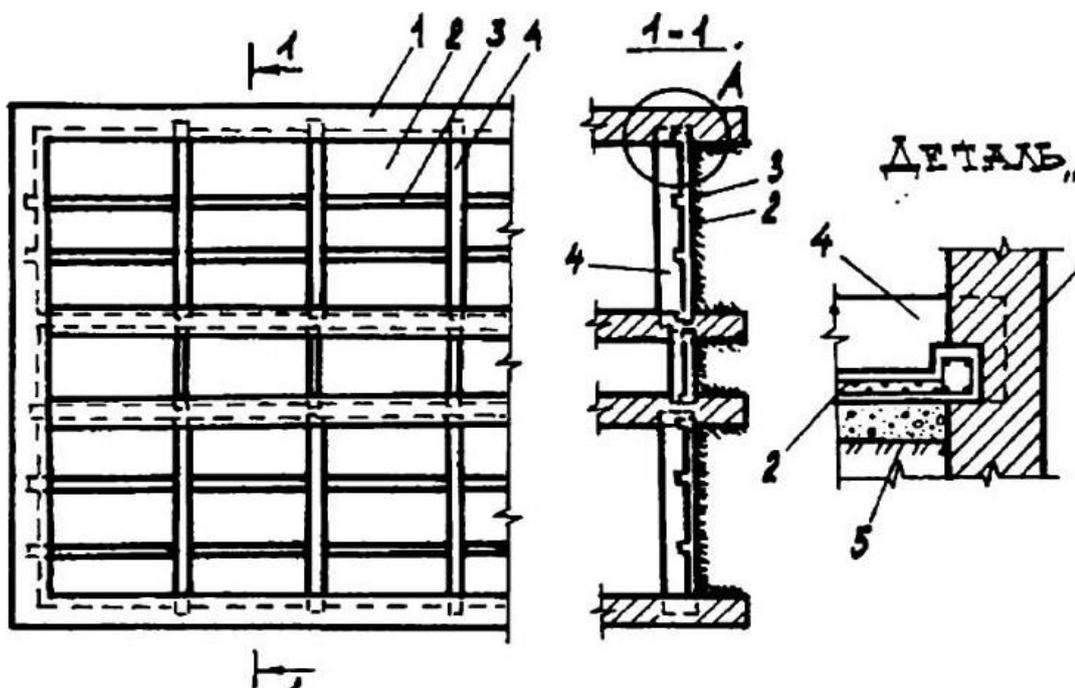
Устройство железобетонной плиты под зданием: 1 – фундамент; 2 – полка плиты; 3 – второстепенная балка; 4 – главная балка; 5 – уплотненный щебень.
